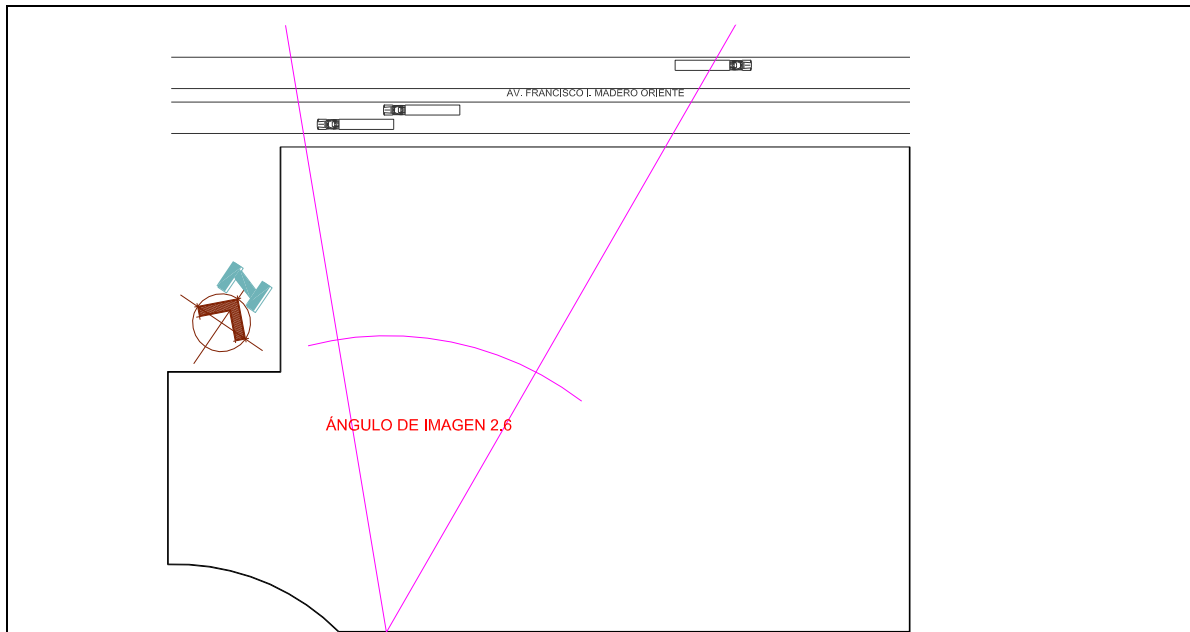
, Plano de ubicación de enfoque de cámara, vista Noroeste. Fuente: Elaborada por el autor.
